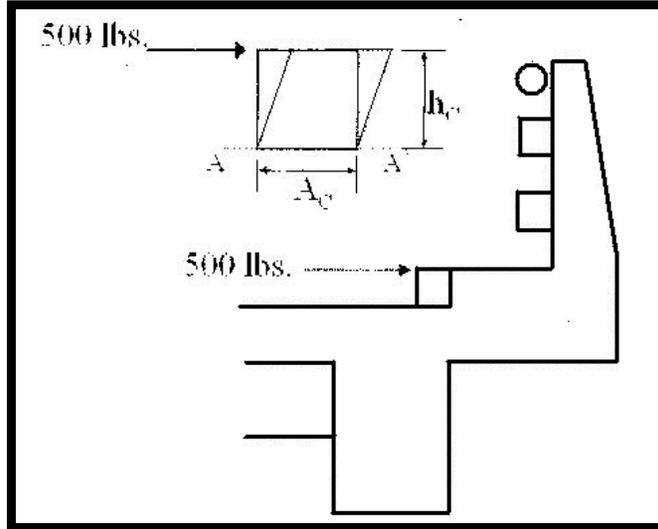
Carga lateral aplicada directamente sobre el cordón
